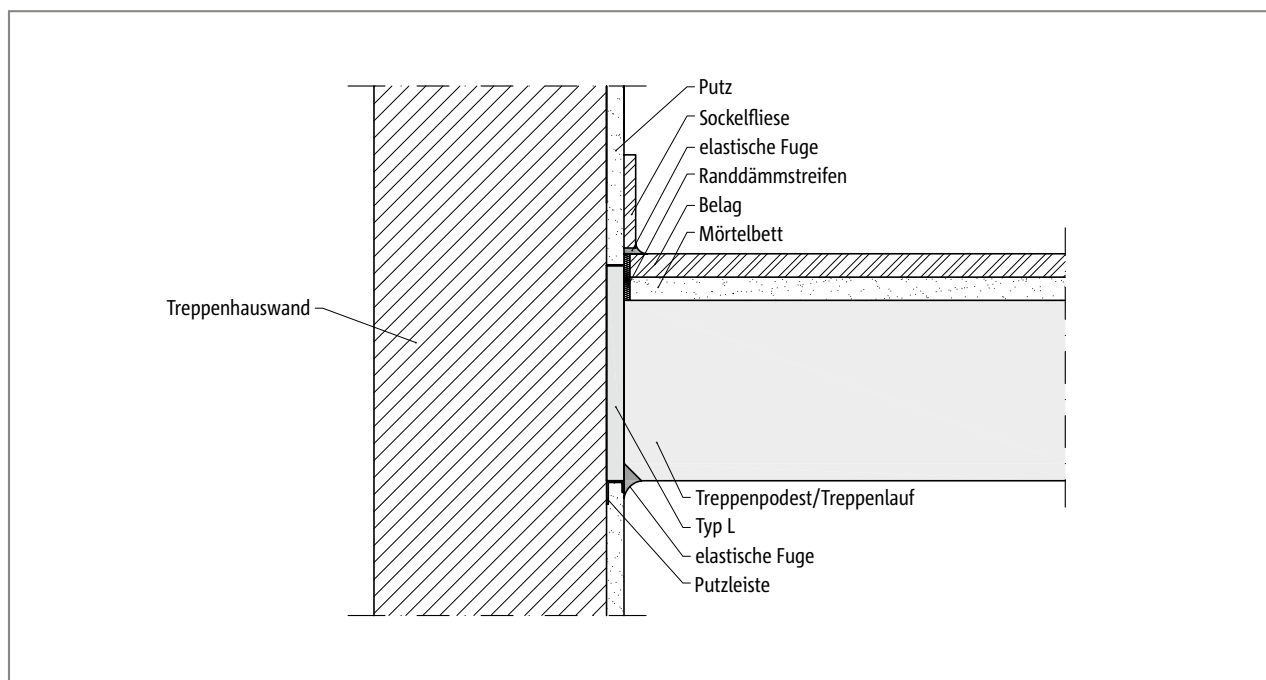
Schöck Tronsole® Typ L: Einbauschnitt Elementtreppe
